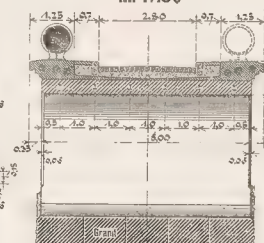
Schnitt durch das Lehr-Gerüst des Fluth-Gewölbes. M. 1:150
